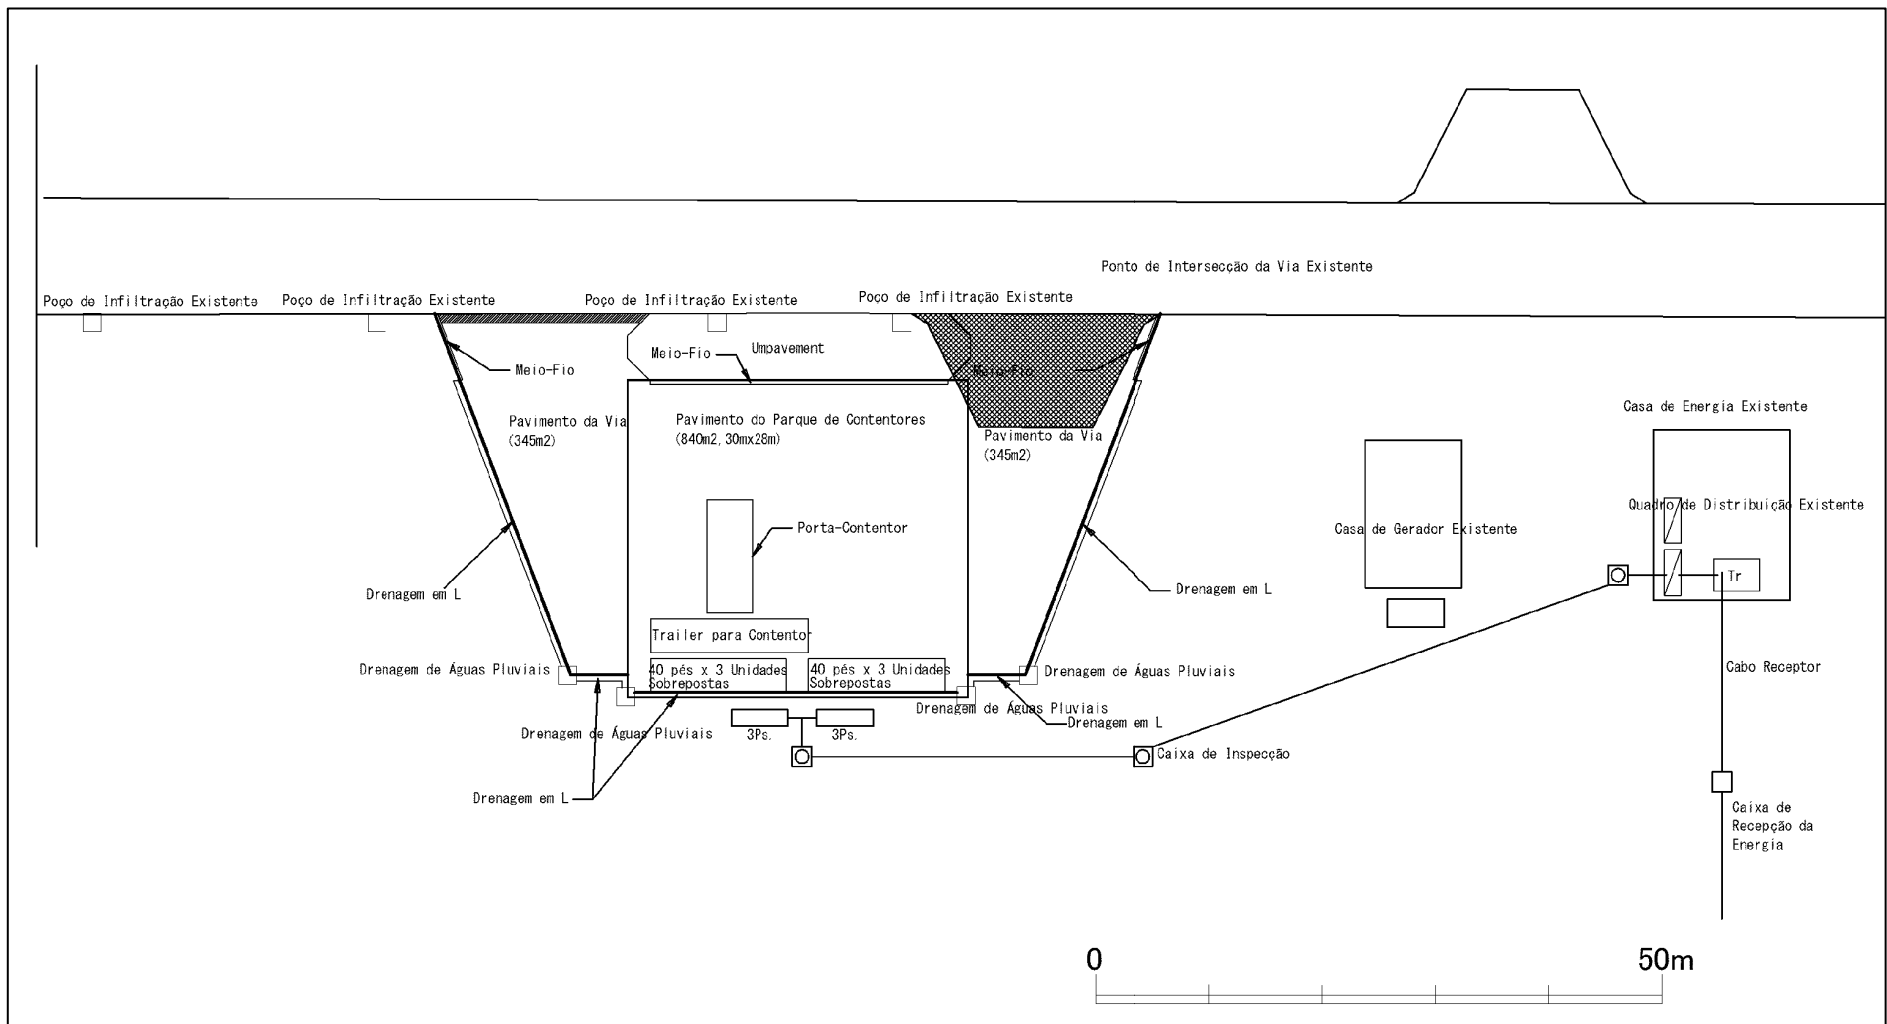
Layout das Instalações para Contentores Frigoríficos
